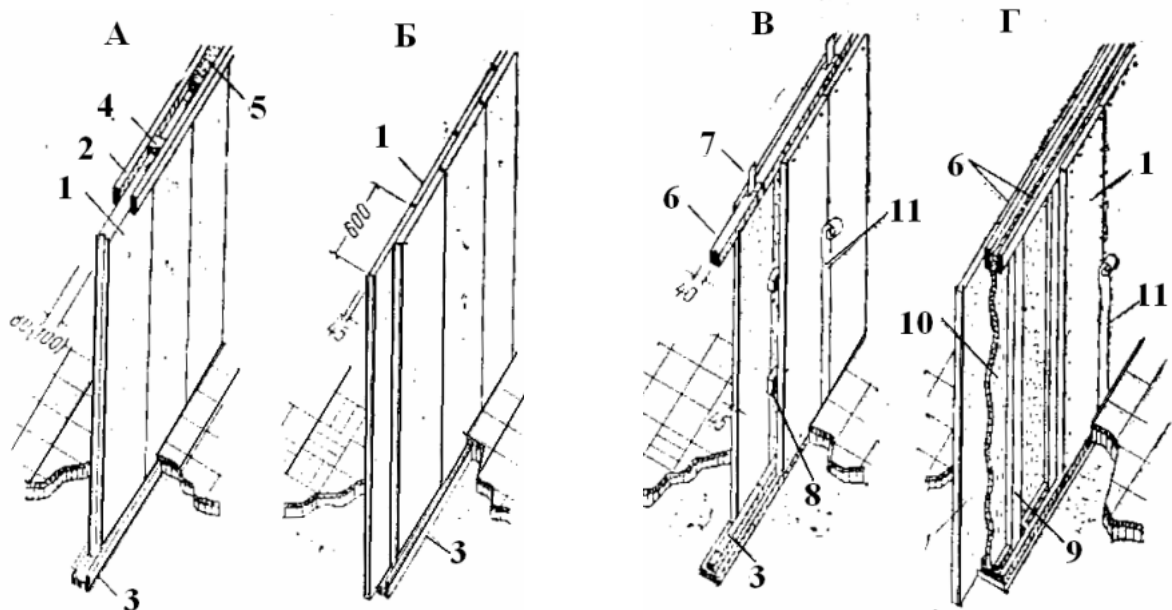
Плитні перегородки: А – одношарова плитна перегородка; Б – двохшарова; В – теж, з повітряним прошарком; Г – з додатковою гідроізоляцією; 1-перегородка; 2-рейки двохстороннього карнизу; 3-нижня рейка; 4-пробка; 5-конопатка; 6-дерев'яна рейка, 40мм; 7-анкер; 8-бобишка; 9-стойка; 10-звукоізоляція; 11-проклејка
